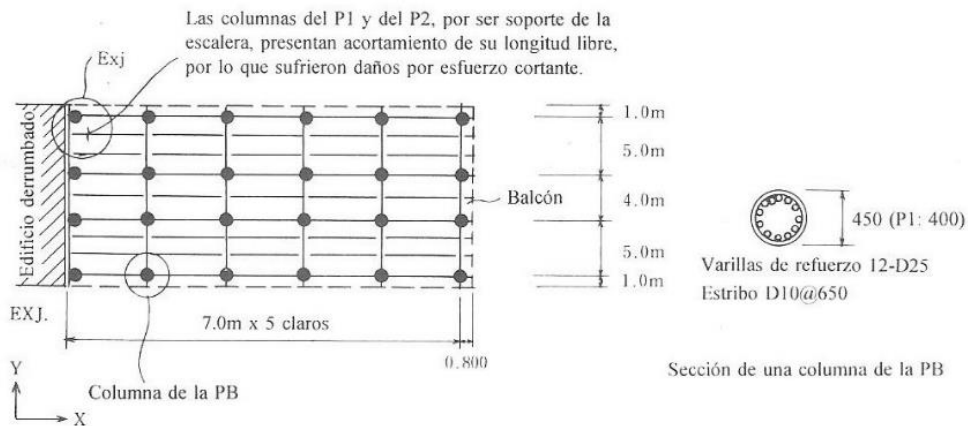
Plata tipo del edificio 245 (Masaki et al., 1996)
